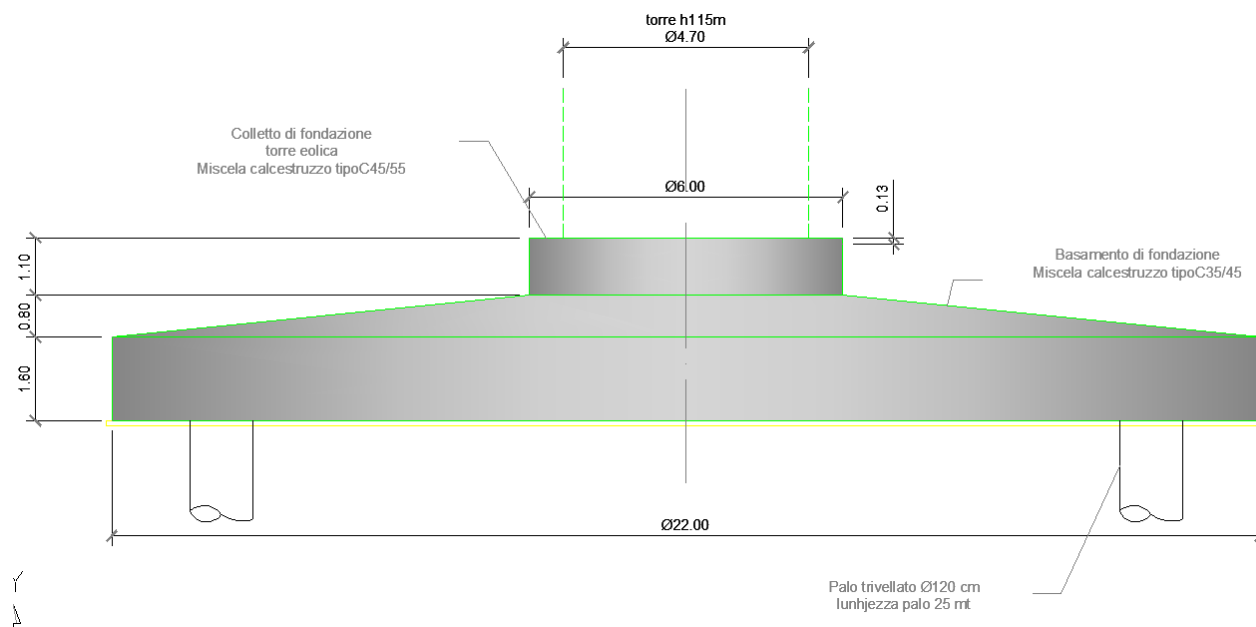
Dettaglio sezione basamento di fondazione in progetto
